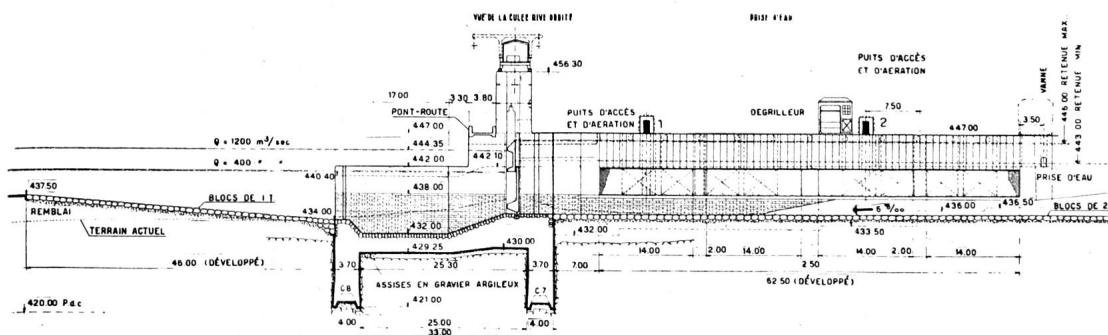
Barrage et prise d'eau, coupe longitudinale. Echelle 1:1200.
